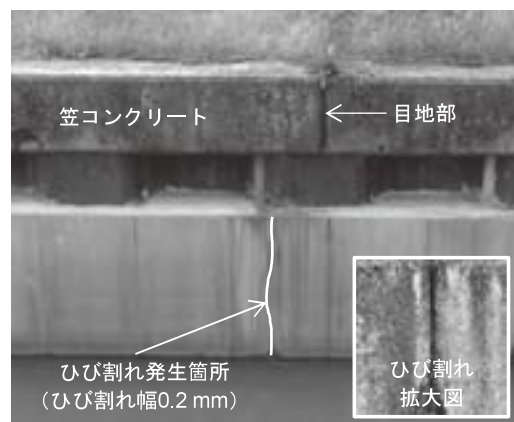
鋼矢板-コンクリート複合材表面のひび割れ
